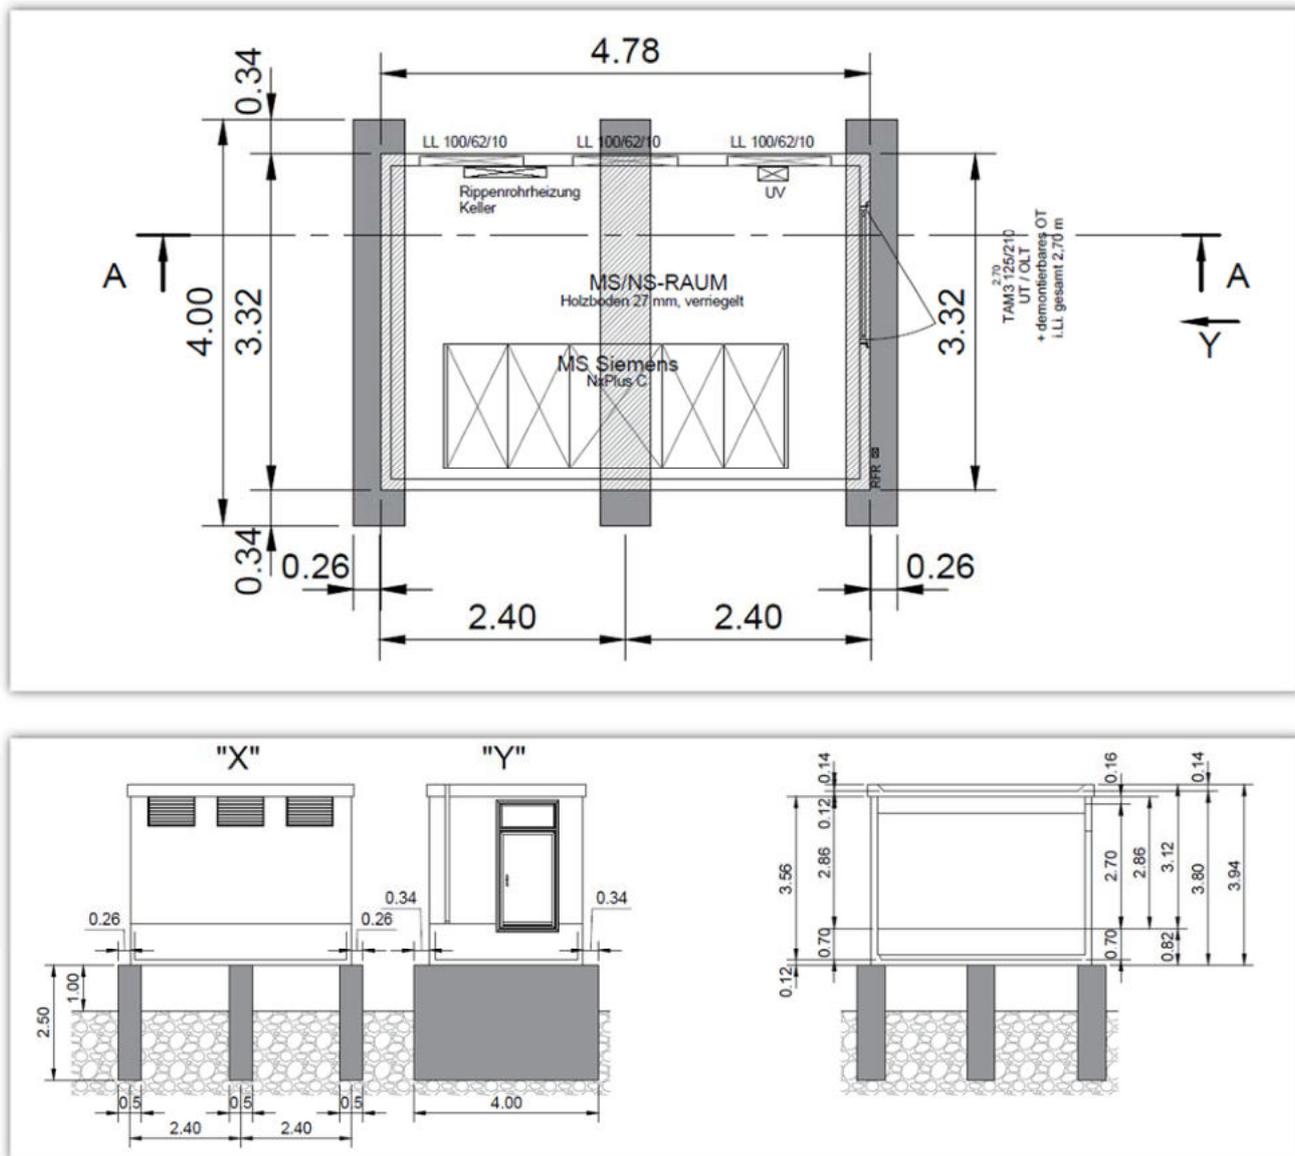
Stralci tratti dagli elaborati di progetto con pianta e sezioni delle Cabine di Raccolta.
